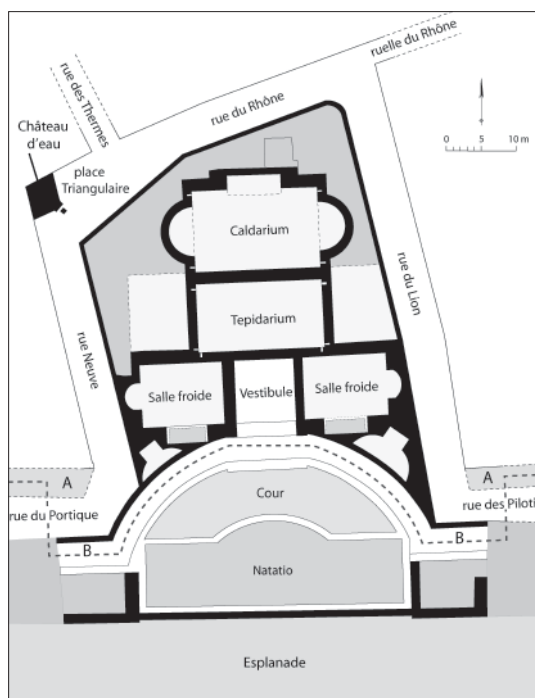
Plan général de l'état initial des thermes des Lutteurs et du réseau viaire adjacent. A : portiques de façade ; B : cheminement piéton à travers les thermes permettant d'éviter le contournement de l'îlot. (L. Brissaud, J.-L. Prisset)
